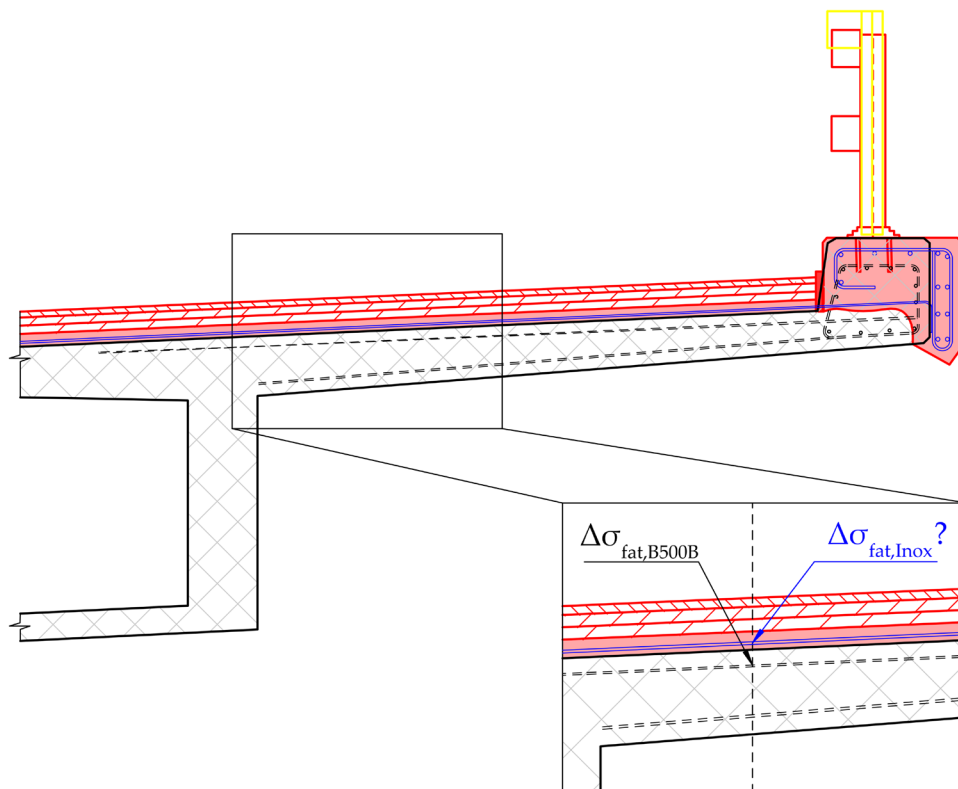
Schematische Darstellung einer möglichen Instandsetzung der Kragplatte einer bestehenden Autobahnbrücke unter Verwendung von nichtrostendem Betonstahl.
